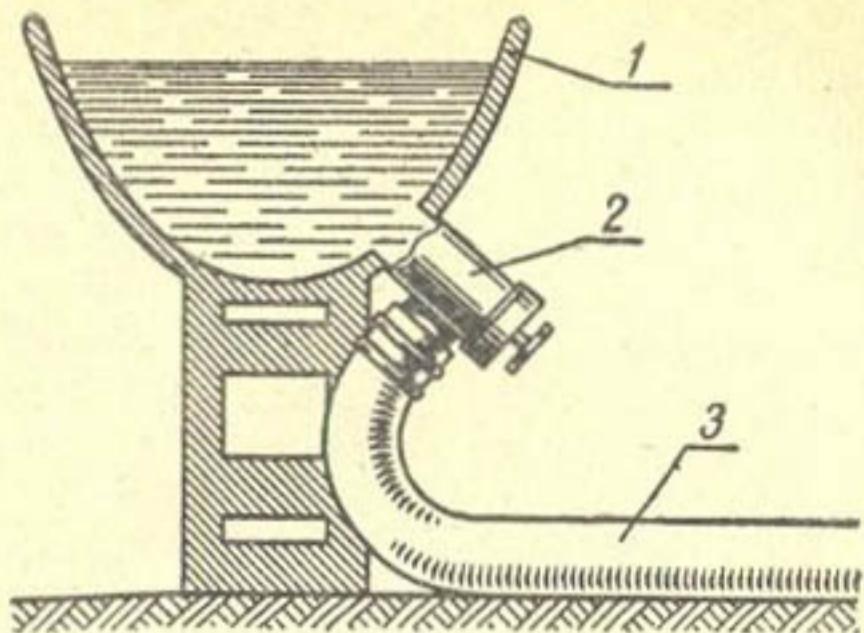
Водовыпуск из лотка в гибкий трубопровод:
